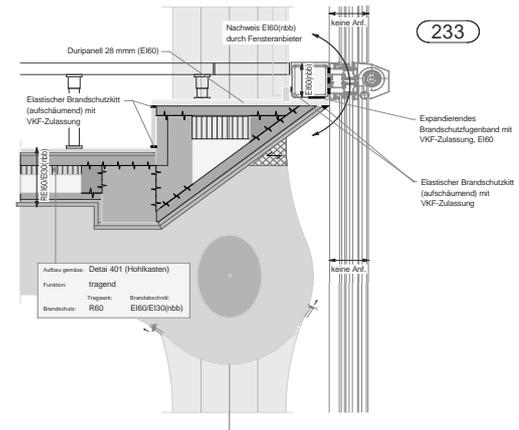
Submissionsdetail 233 – Geschossdeckenübergang Fassade
